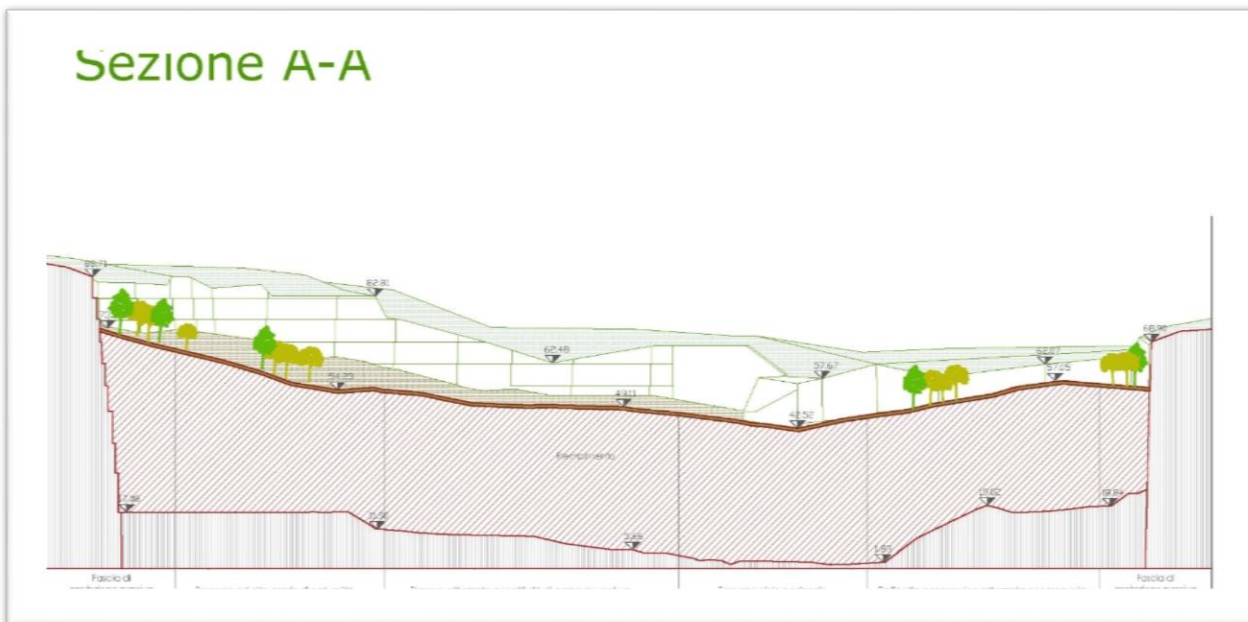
Sistemazione finale della cava: sezione longitudinale di progetto
